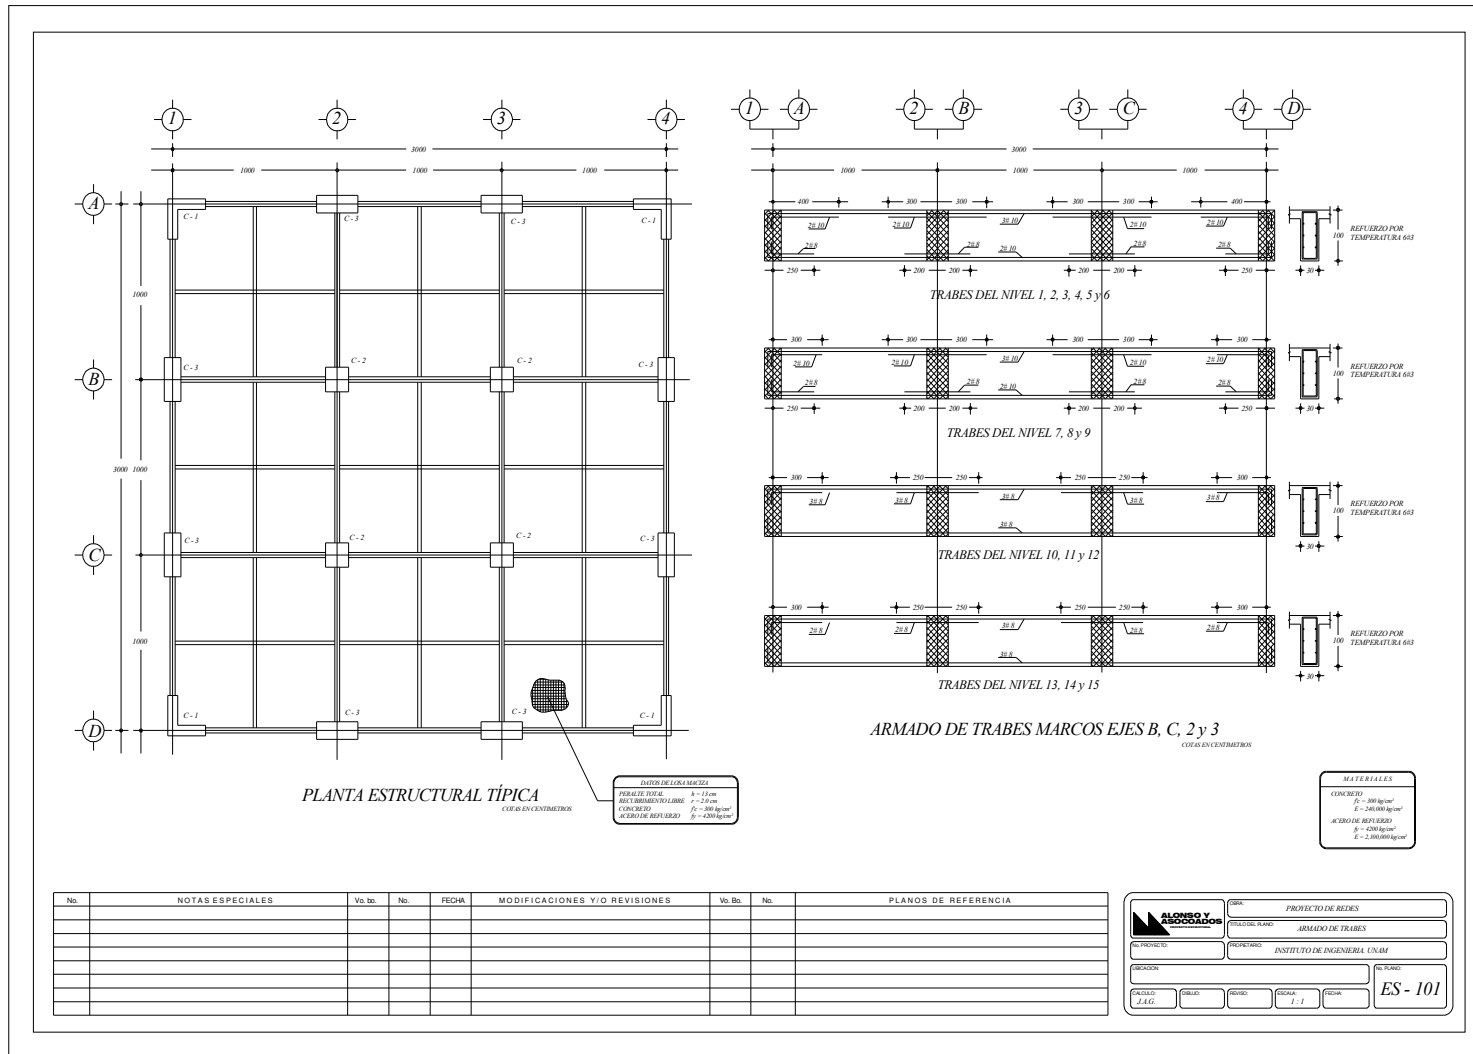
Secciones estructurales del edificio de 15 niveles
